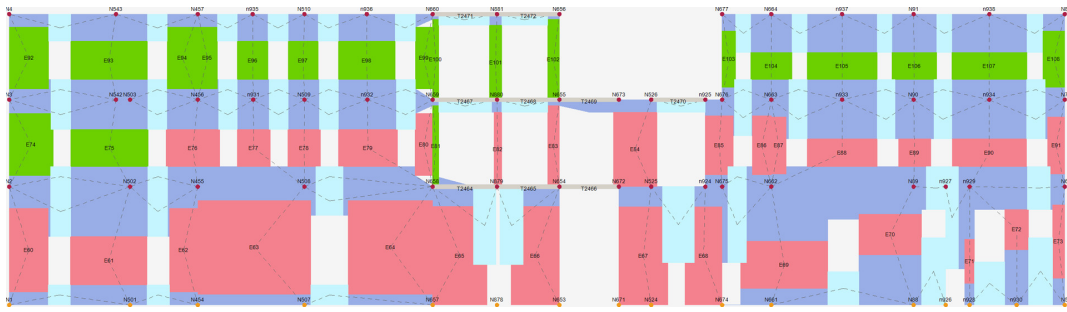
Verifiche statiche SLU maschi murari piano primo.
